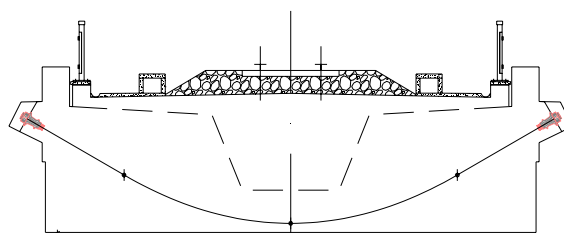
Traçado esquemático do pré-esforço instalado nas carlingas
